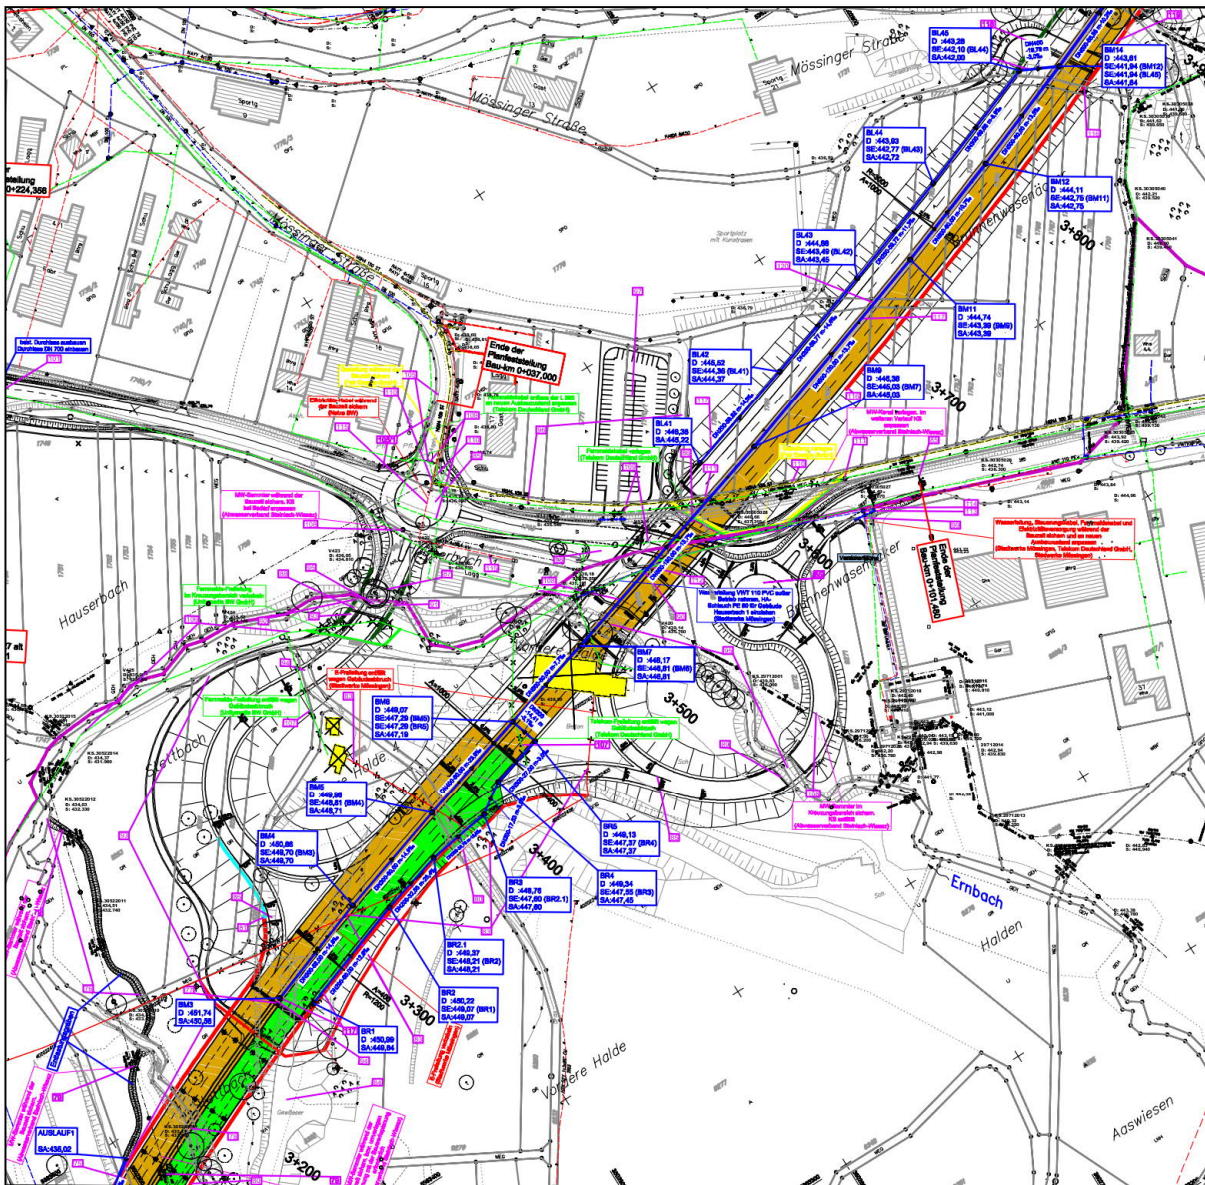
Entwässerungsabschnitt 2: Stationen 3+200 bis 3+800. Straßenflächen mit erforderlicher Behandlung (Flächen, die nicht breitflächig in den Böschungen zur Versickerung gebracht werden können). Ohne Maßstab
